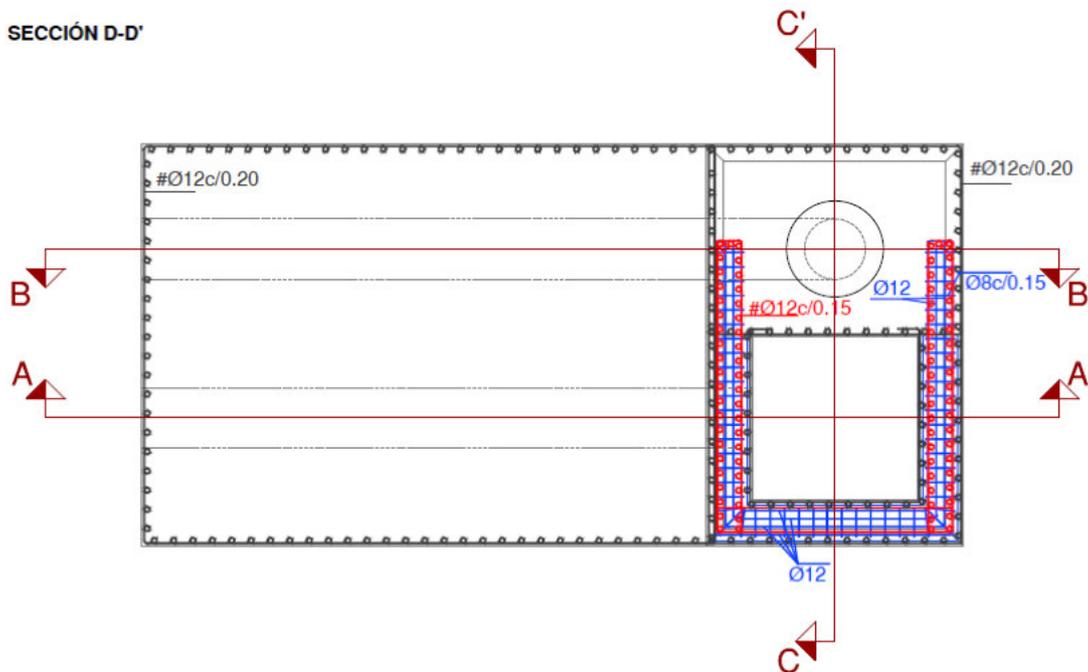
Vista en planta de los armados. Fuente: Elaboración propia.
